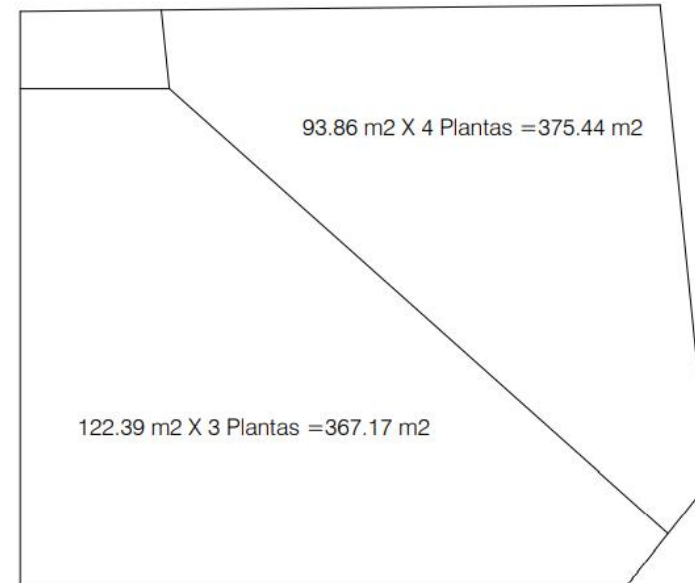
Imagen del plano de superficie construida de la primera, segunda y tercera planta. (Fuente: GREEN SOLID S.L)
